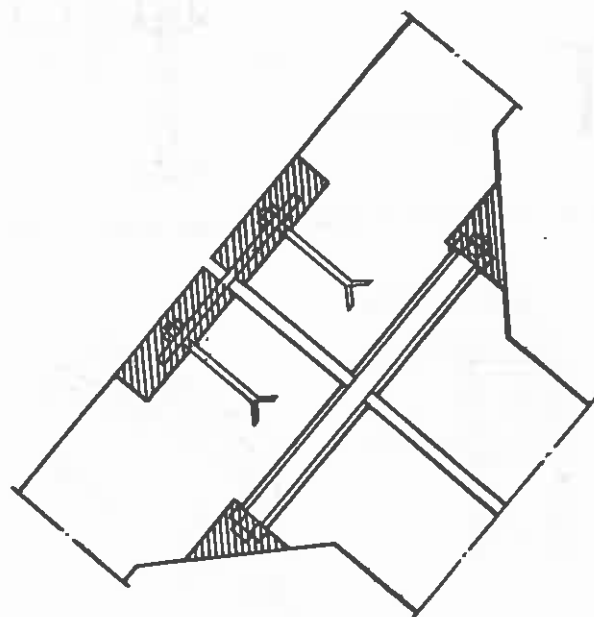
Pormenor de ligação de asna fabricada por partes
